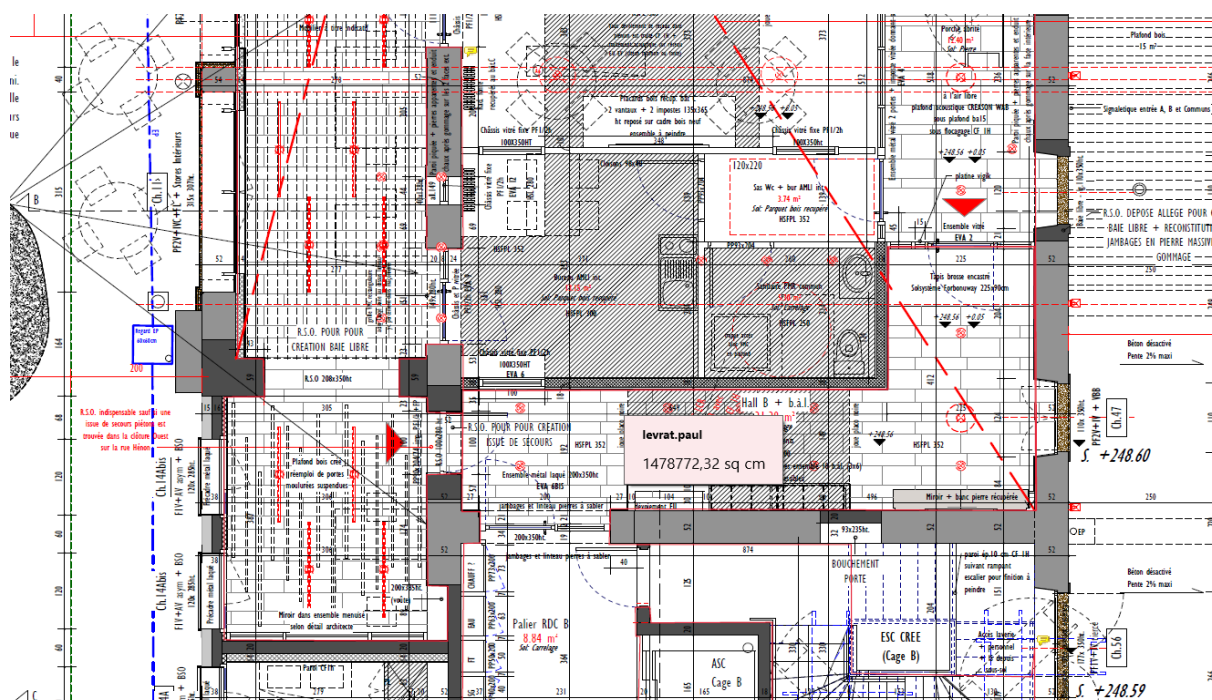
exemple de métré sur le plan RdC du bâtiment B
